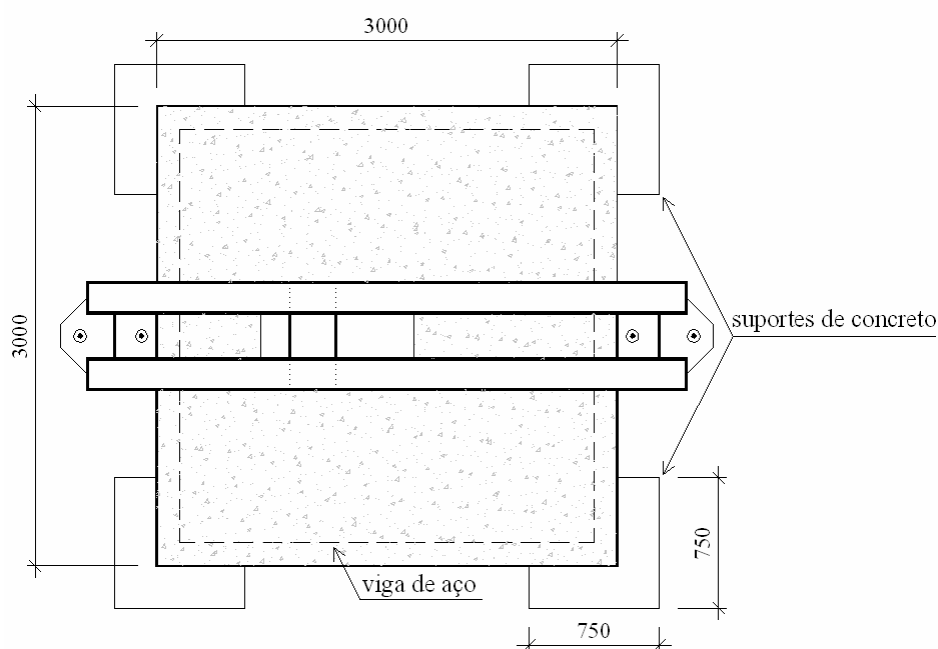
Sistema de ensaio das lajes de Krüger *et al.* – Planta Baixa (2000)
